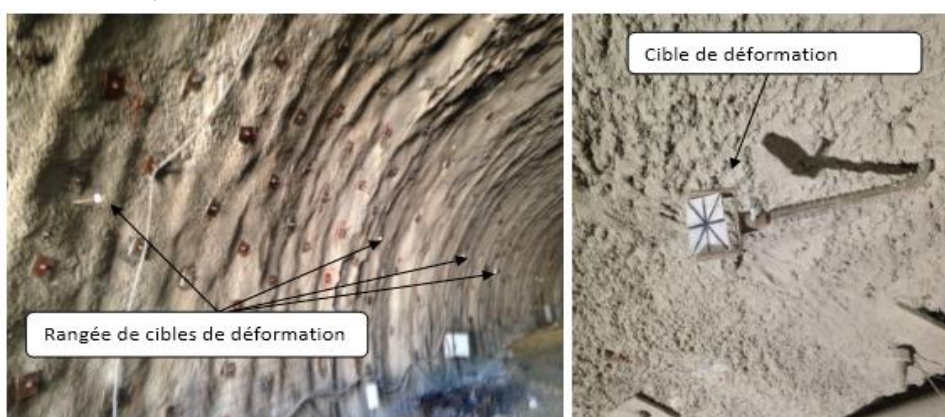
Cibles de déformation (Tunnel d'Ait Yahia Mousse- 23/04/2017)
